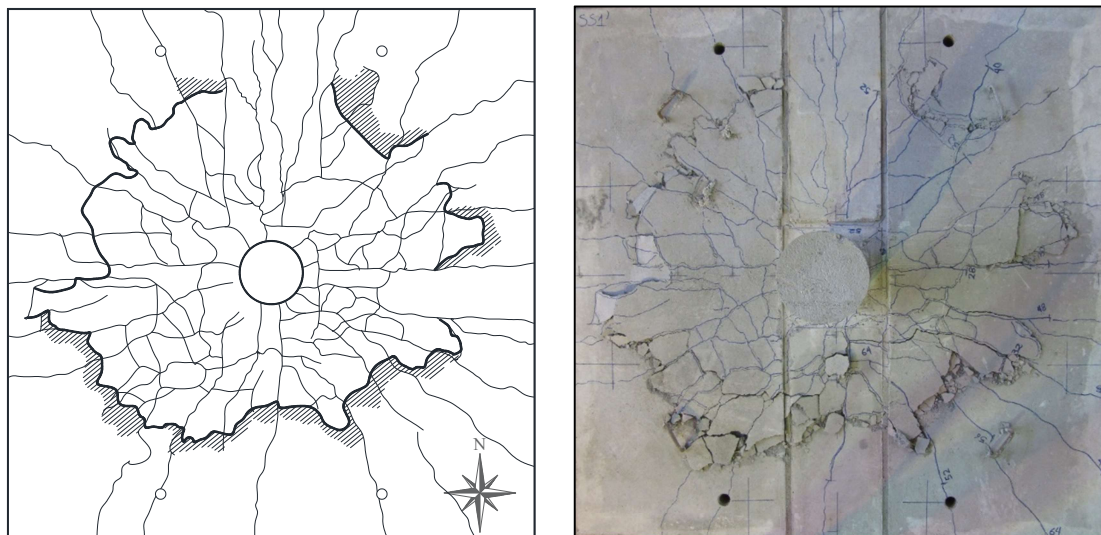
Mapa de fissuração da laje SS1 3ª Série
